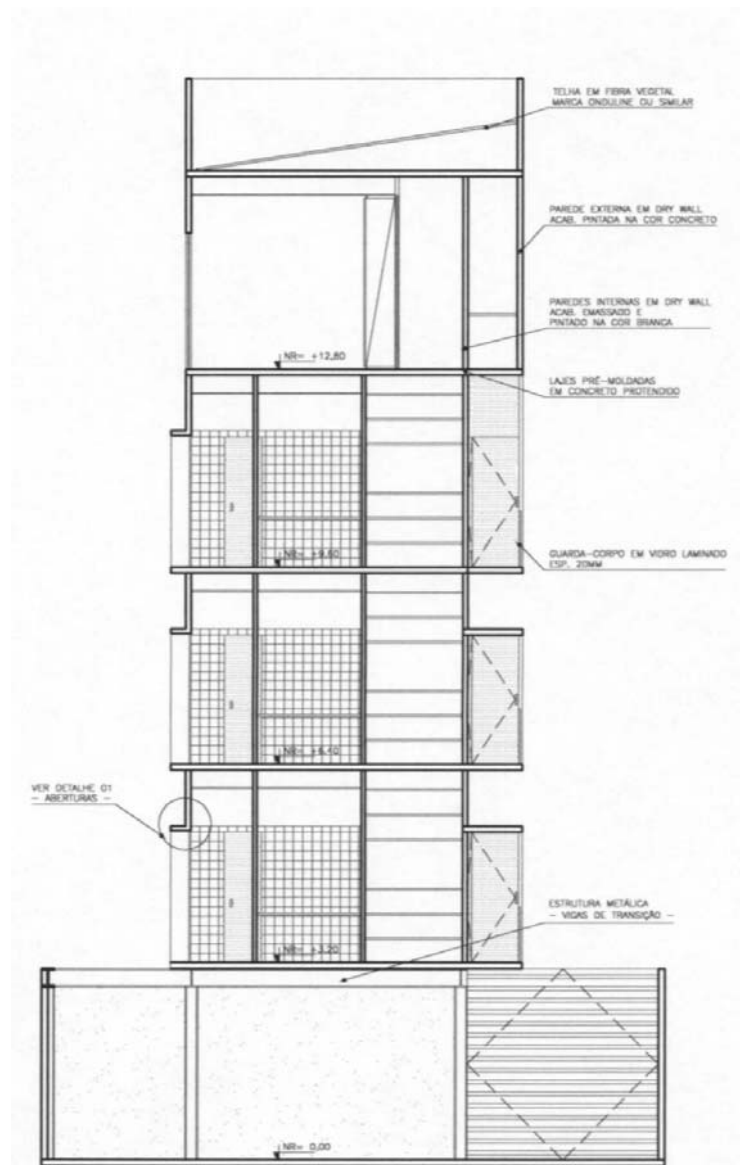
Corte transversal do projeto da equipe 2, mostrando estrutura e sistema construtivo.
